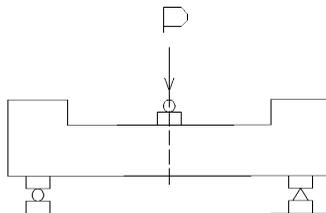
Схема испытания продольных стенок блока на изгиб
